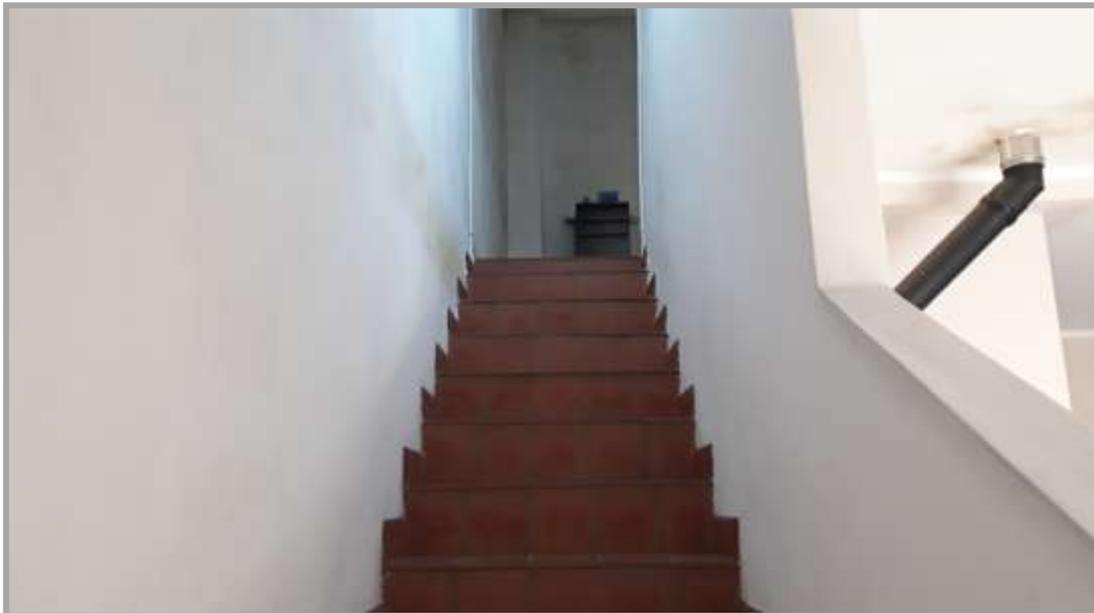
" – Vista delle scale di accesso al piano sottotetto
